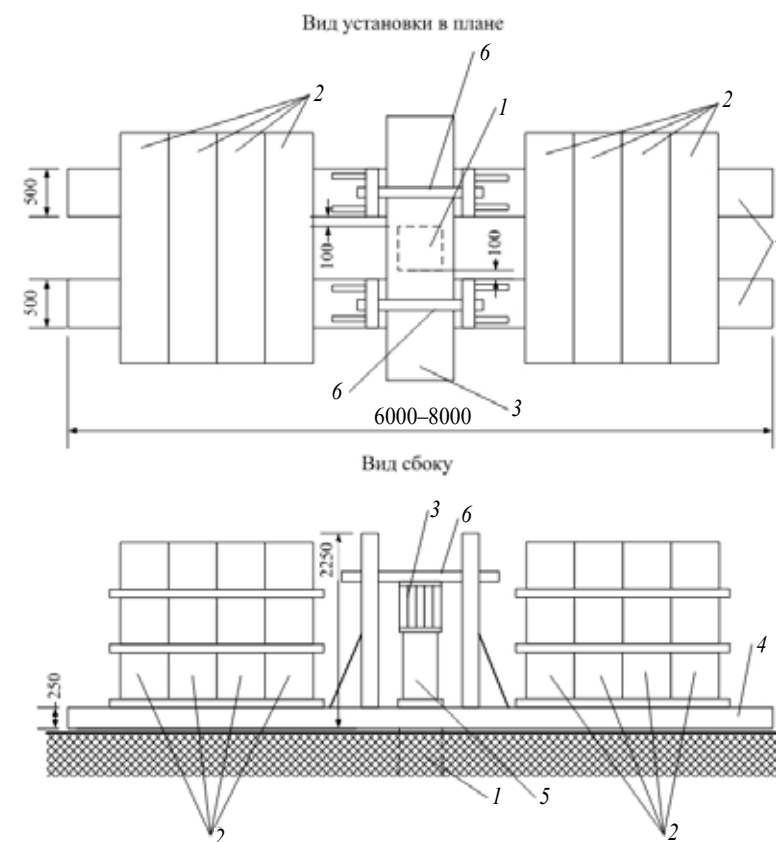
Схема испытания с помощью грузовой платформы и инвентарных грузов: 1 – свая; 2 – инвентарные металлические грузы на деревянных прокладках; 3 – упорная балка; 4 – станина; 5 – домкрат; 6 – стопорный палец; реперная система контроля осадок сваи не показана
